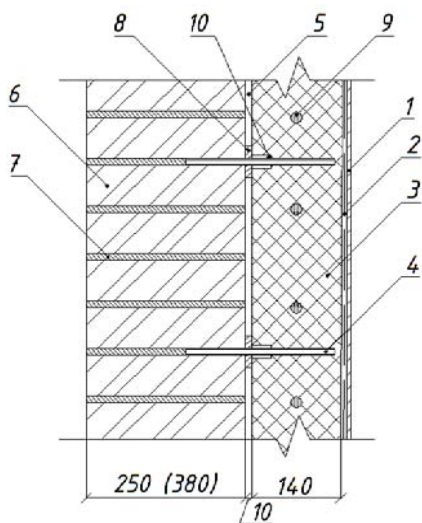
Конструктивное решение двухслойной кирпичной кладки с плитным утеплителем:
